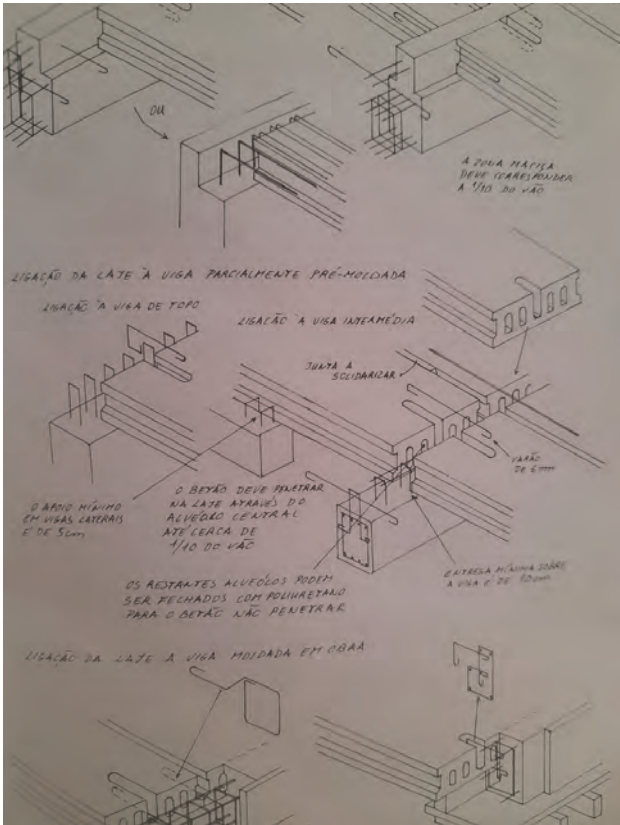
Várias soluções para a união entre lajes alveolares e vigas de betão.
